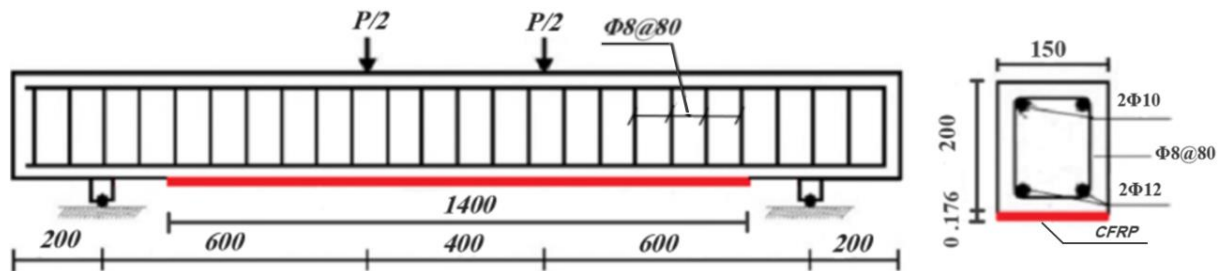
Détails de la section transversale et longitudinale de la poutre en béton armé renforcée en flexion par *CFRP* (dimensions en mm) [1].
